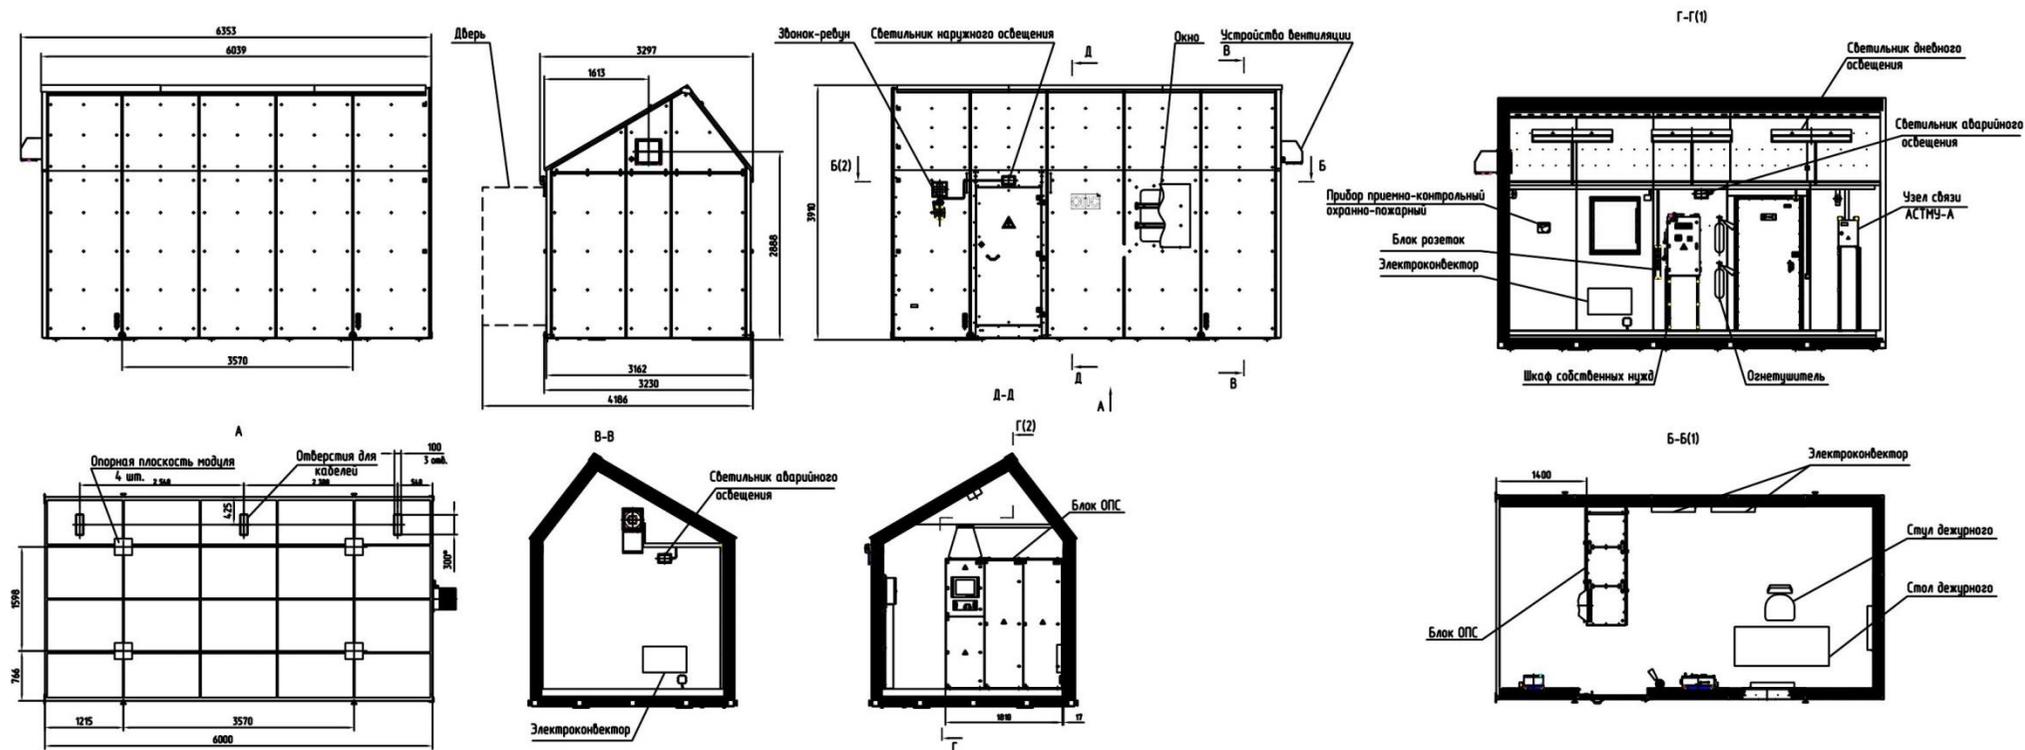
Габаритный чертеж модуля ОПС с правой торцевой стенкой
